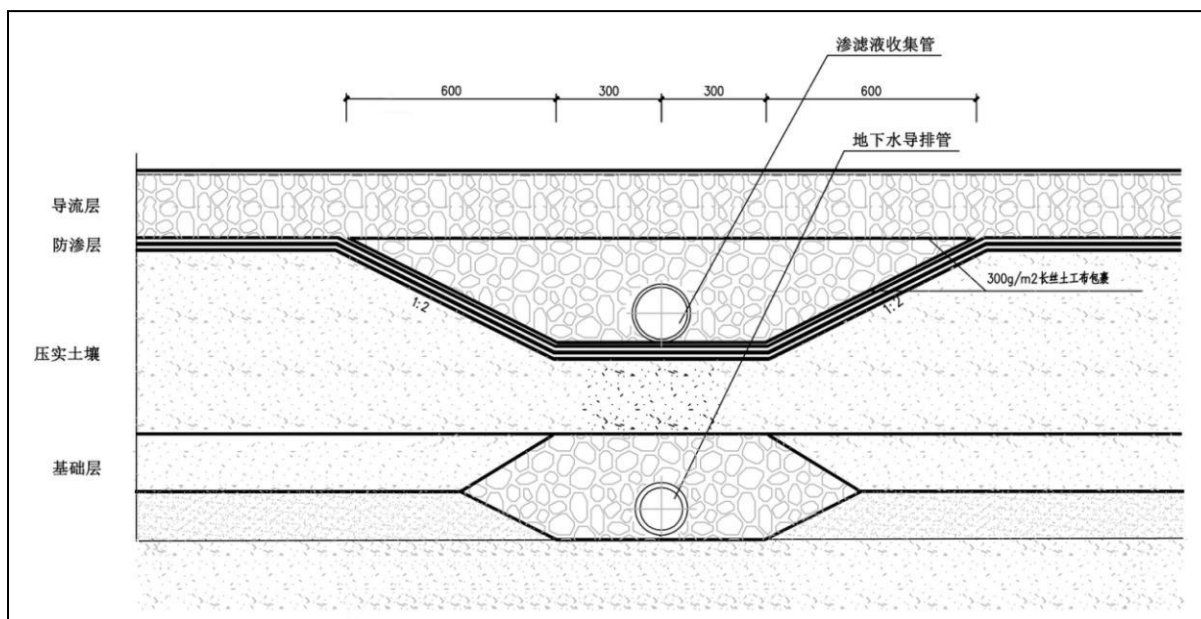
渗滤液收集主管和地下水收集主管剖面图
